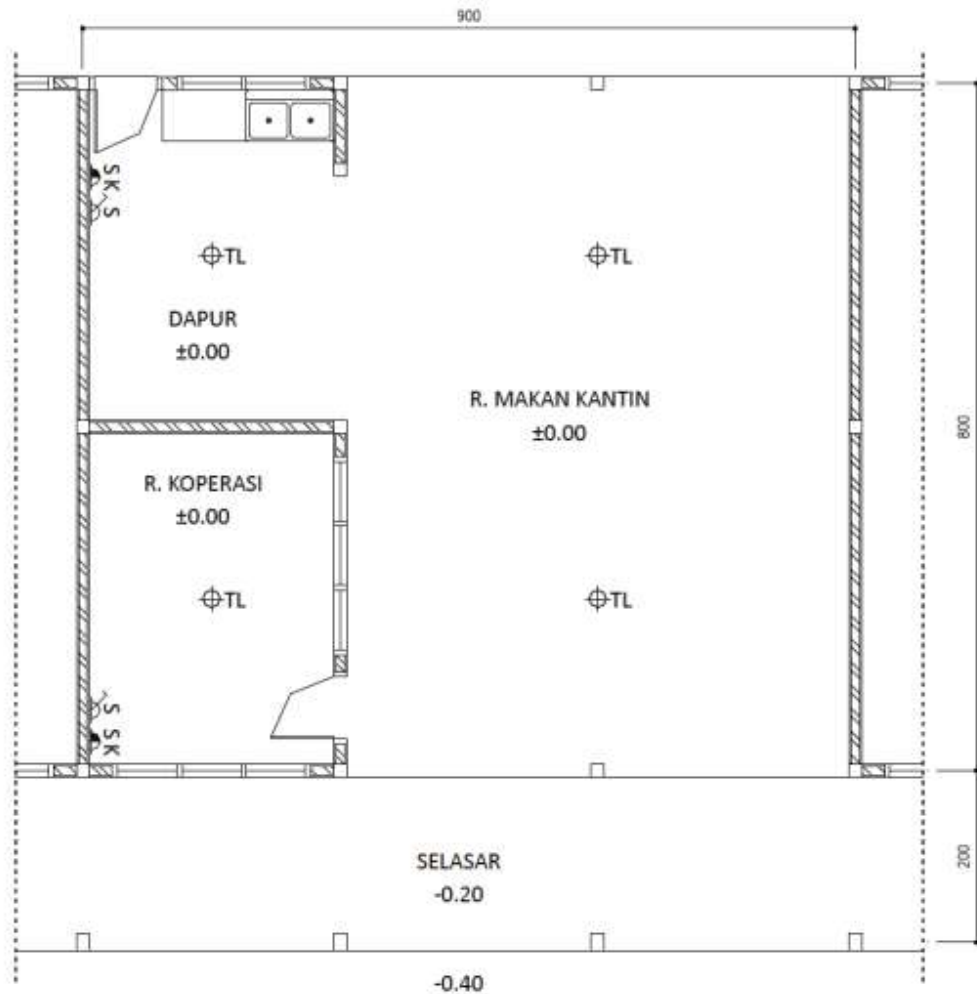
18 Denah Standar Ruang Fungsi Penunjang
